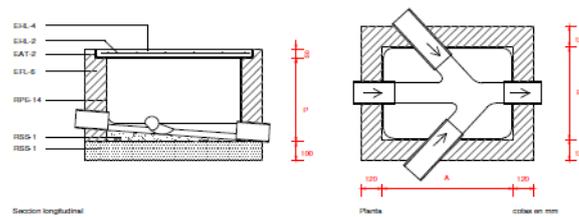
Detalle en planta y sección de una arqueta de paso y otra arqueta a pie de bajante (Apuntes)
